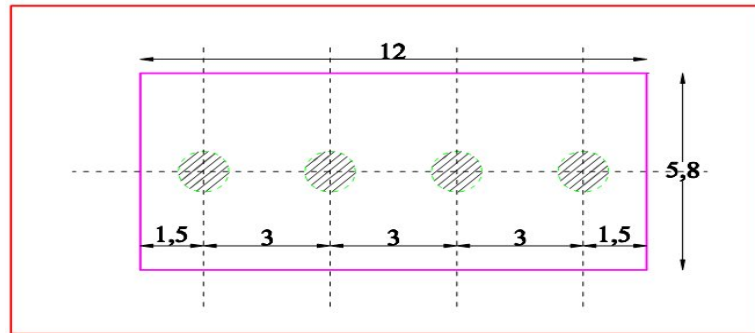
la disposition linéaire des pieux sous la semelle.
